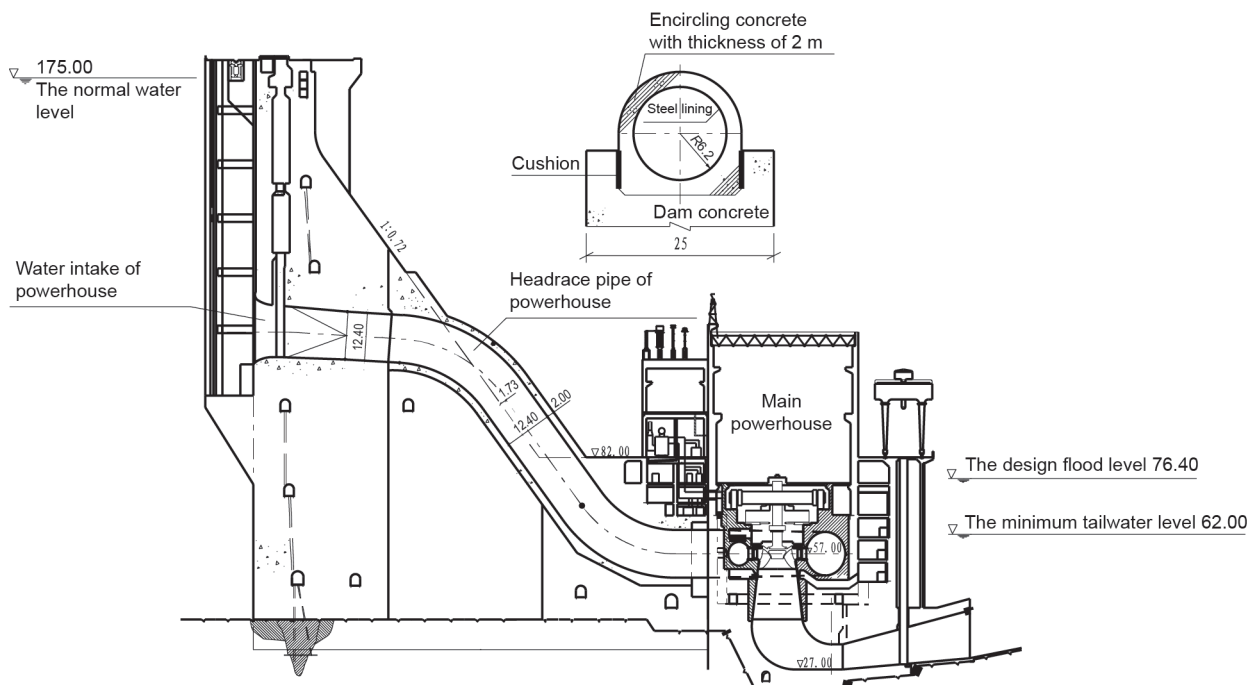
引水压力钢管预留浅槽布置与钢衬钢筋混凝土管道示意图。
